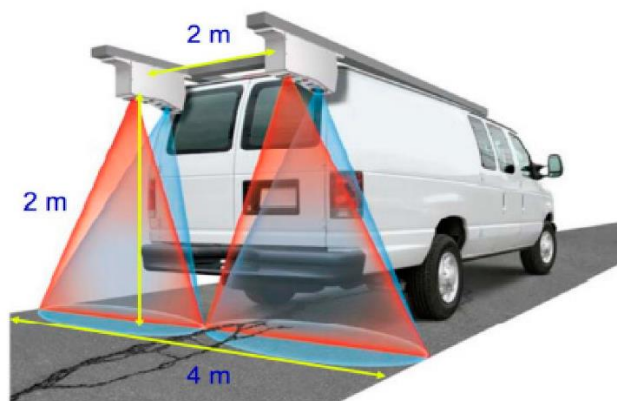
Laser Crack Measurement System - LCMS (Fonte: Huang et al., 2024).
